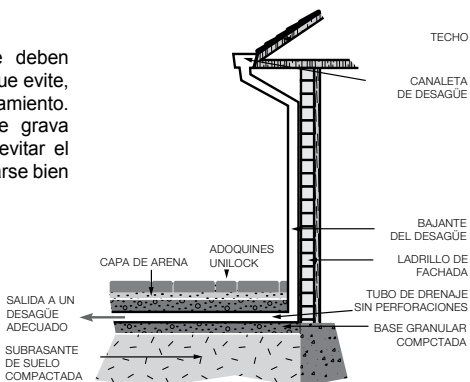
La escorrentía siempre debe dirigirse hacia la elevación más baja
